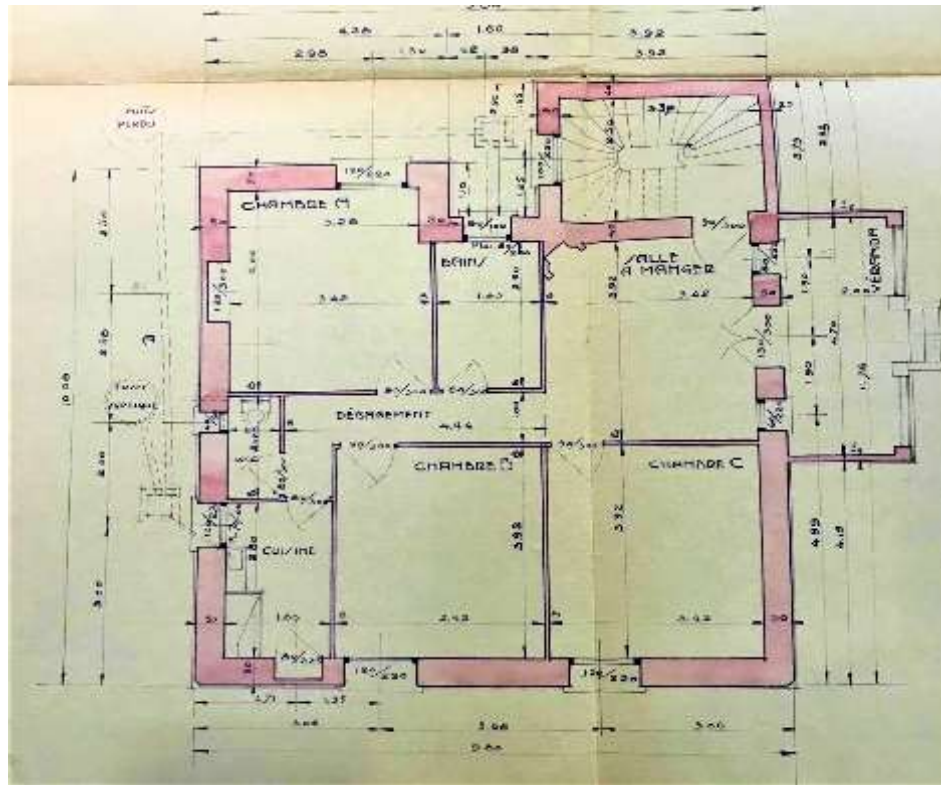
Plan du rez-de- chaussée, de la villa Corcos (1926), Architecte : I. Zimbris
